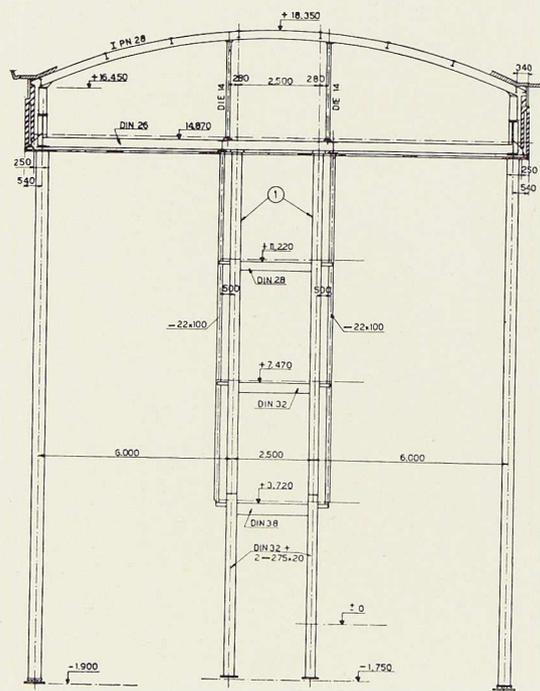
Elévation du portique de liaison des façades Nord et Sud.
